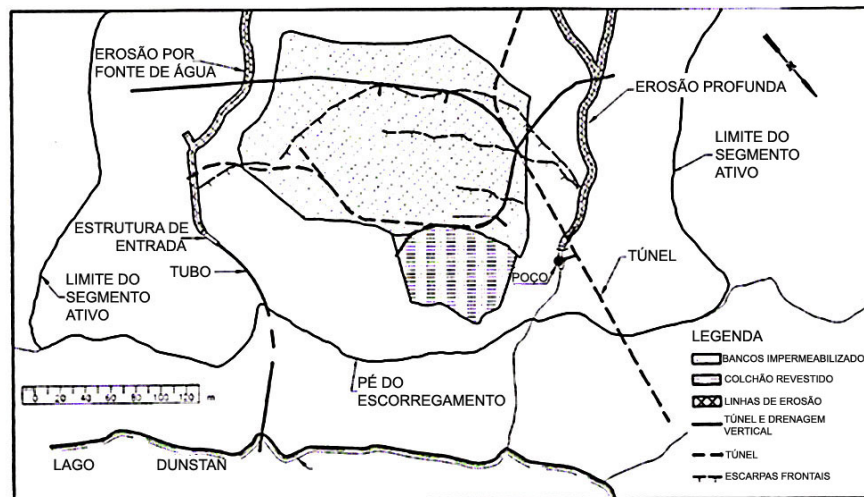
Planta do local (Gillon e Saul, 1996).
